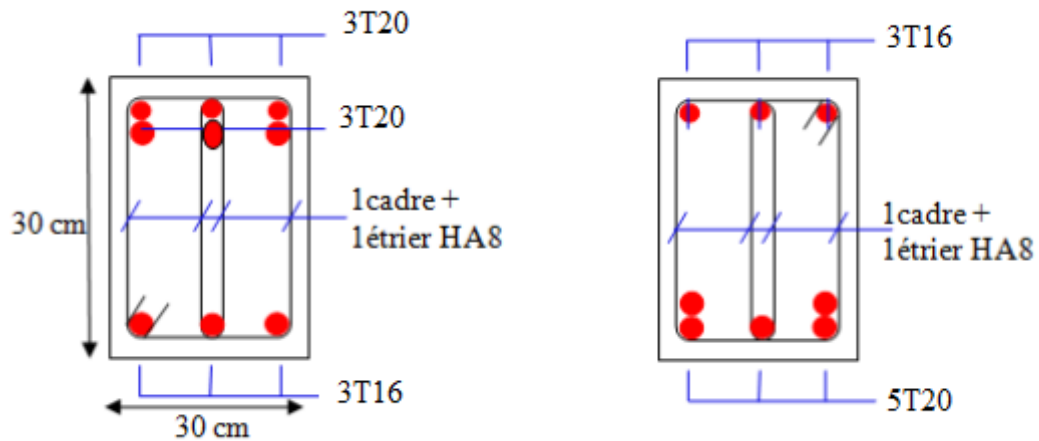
Schéma de ferrailage de la poutre secondaire.
